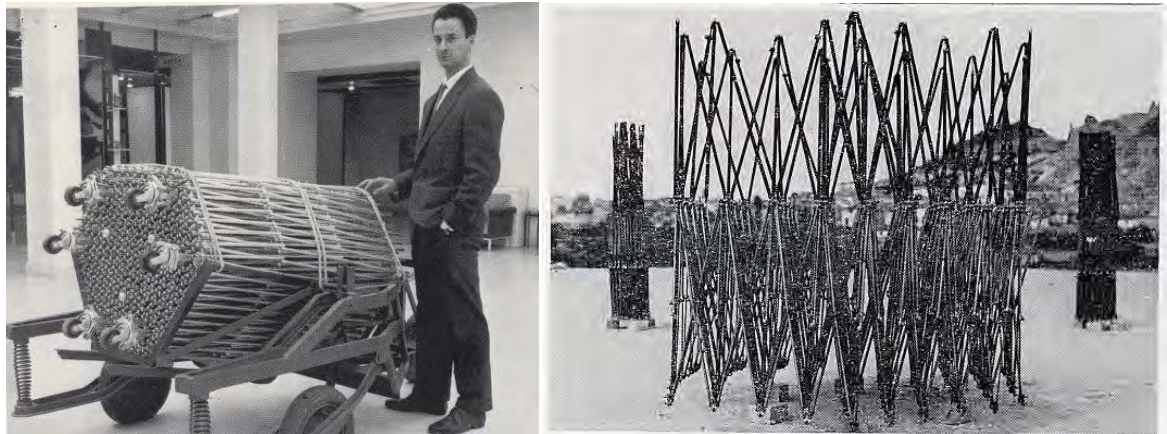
Estructuras auto-armables del arquitecto español Pérez Piñeiro.
